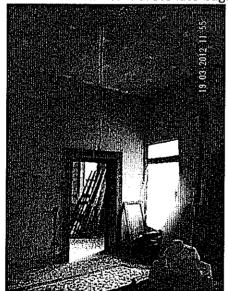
Stanza 1.6 - Vista finestra lato corte
